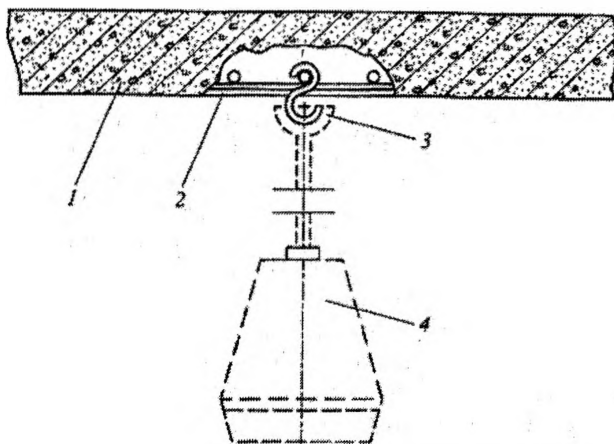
Установка гака приварюванням до арматур перекриття: 1 — перекриття; 2 — арматура металева; 3 — гак; 4 — світильник
